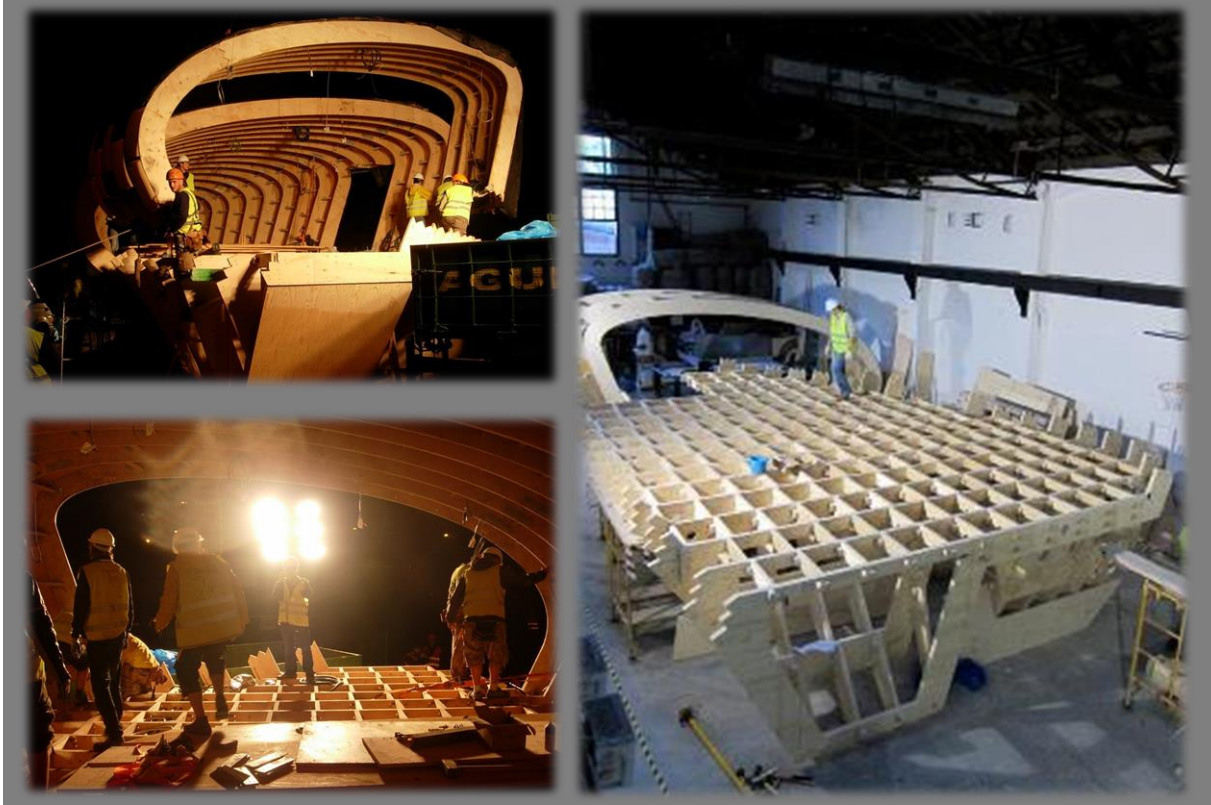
Basamento y cubierta de la piel de losa. Fuente: Archivo personal.
